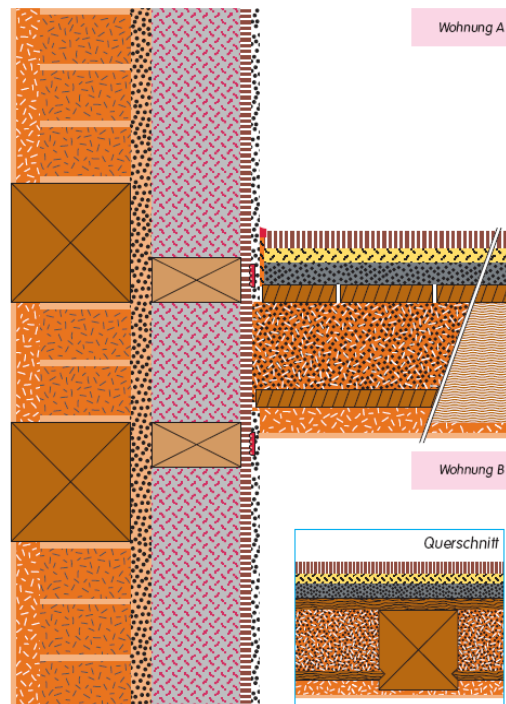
Deckenanschluss Fachwerk mit Innendämmung (condetti® Detail) [4].
